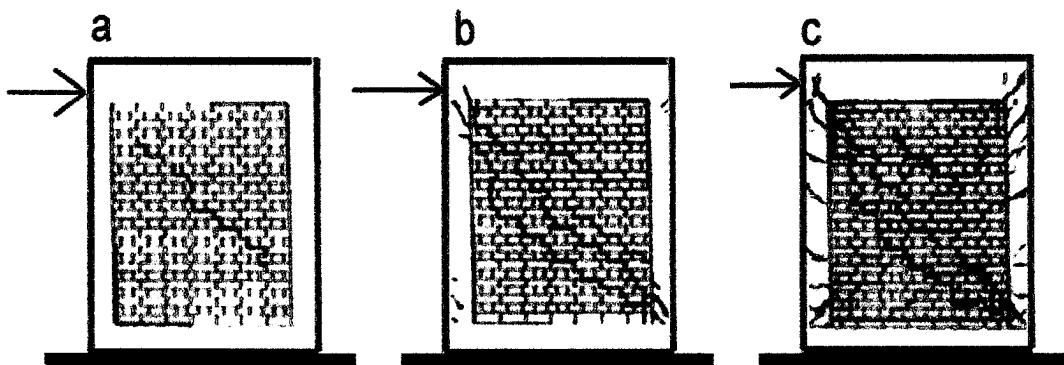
a) Grieta diagonal, b) Falla de la mampostería y comienzo del daño en las columnas, c) Daño total del espécimen.
